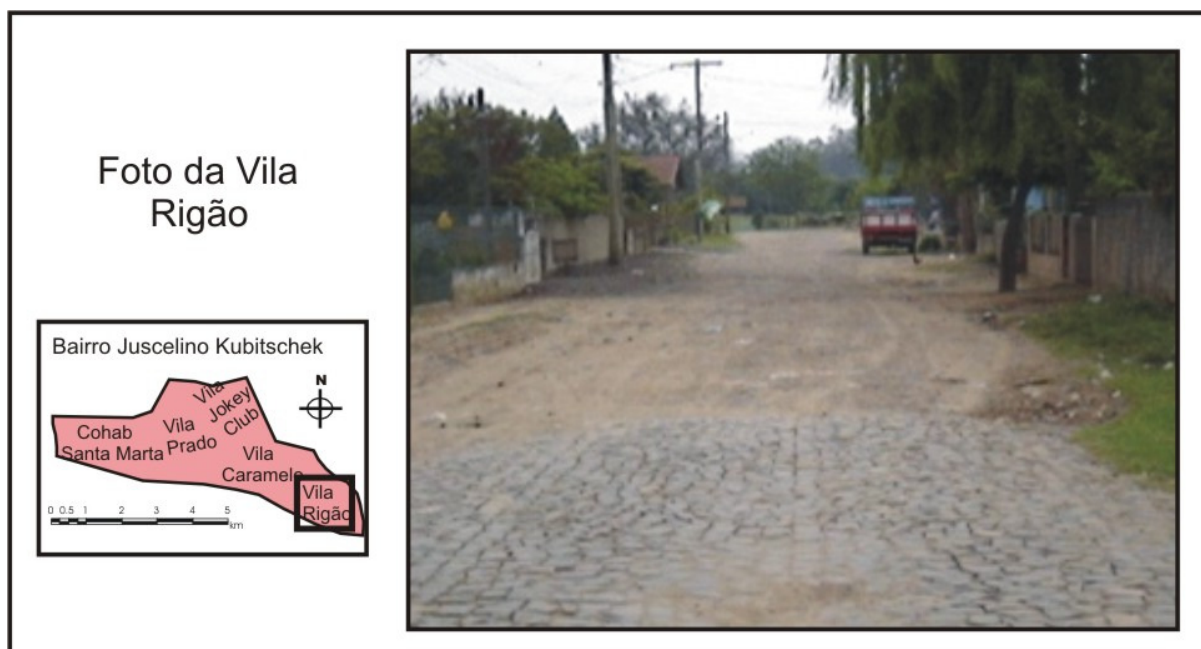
Foto da Vila Rigão – pavimentação precária e falta de bueiros
